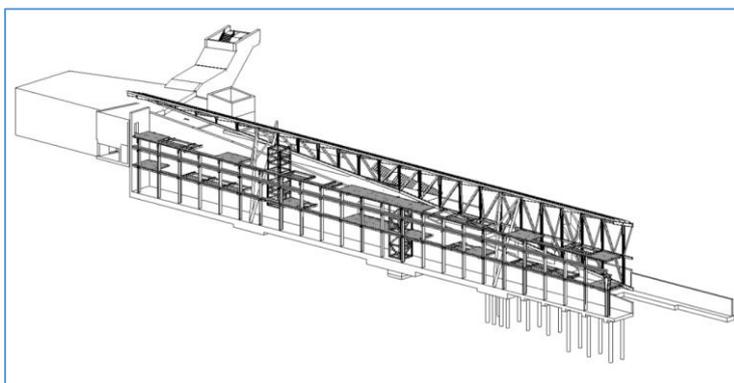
Vista 3D da treliça norte e pilares de apoio em “V”
